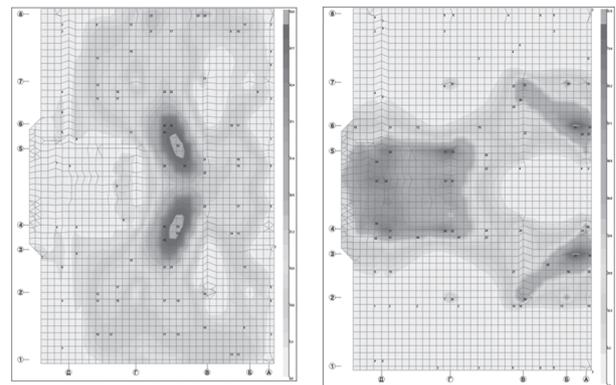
Армирование плитного ростверка: а) верхняя арматура вдоль оси X; б) нижняя арматура вдоль оси Y
